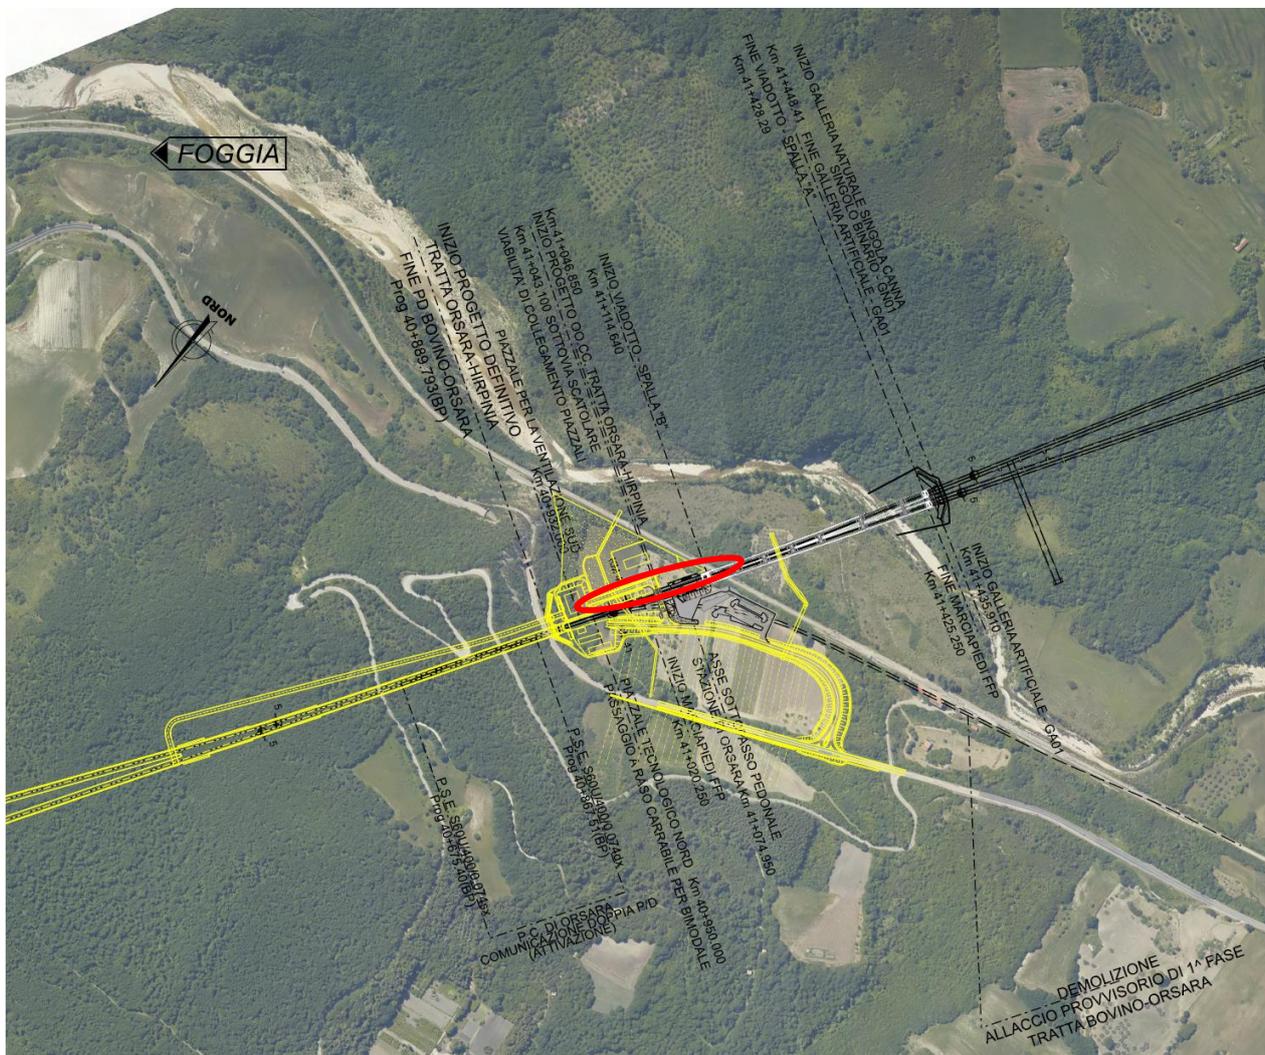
Individuazione su foto aerea dell'ambito di progetto (con tratto nero) interessato dalla prescrizione
